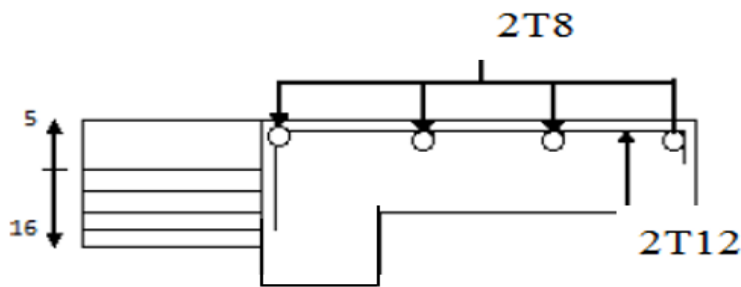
Ferrailage de la dalle pleine de type 1 étage courant
